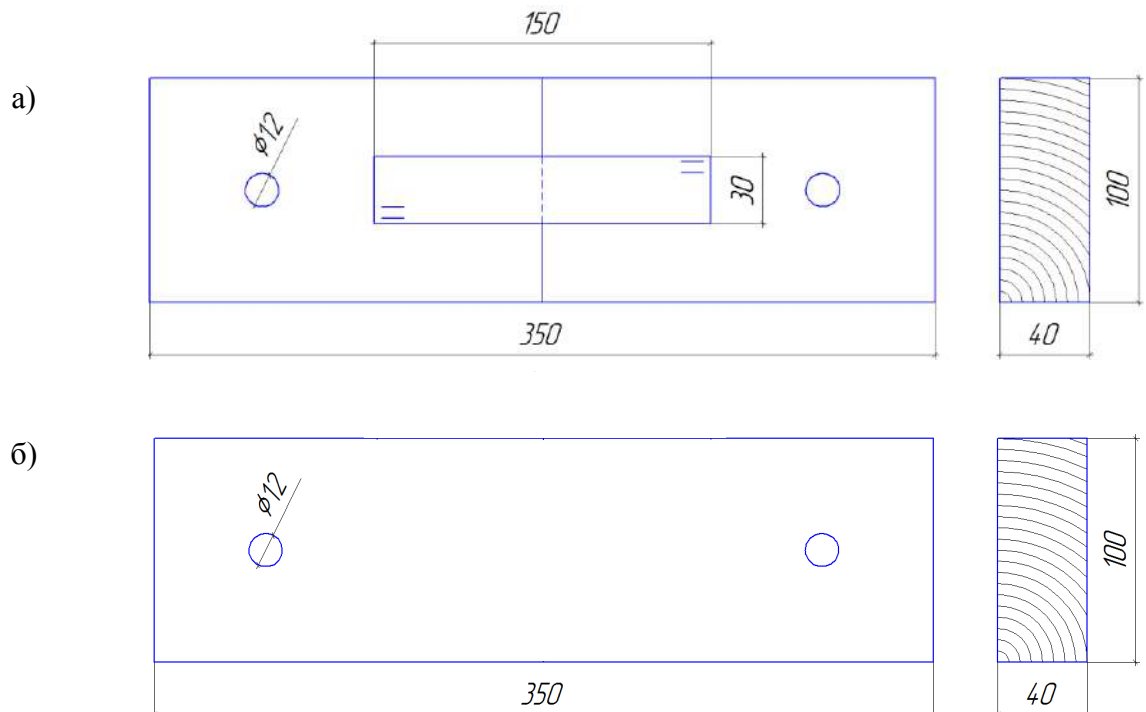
Конструкция испытуемых образцов: а – нагельное соединение на МЗП; б – болтовое нагельное соединение
